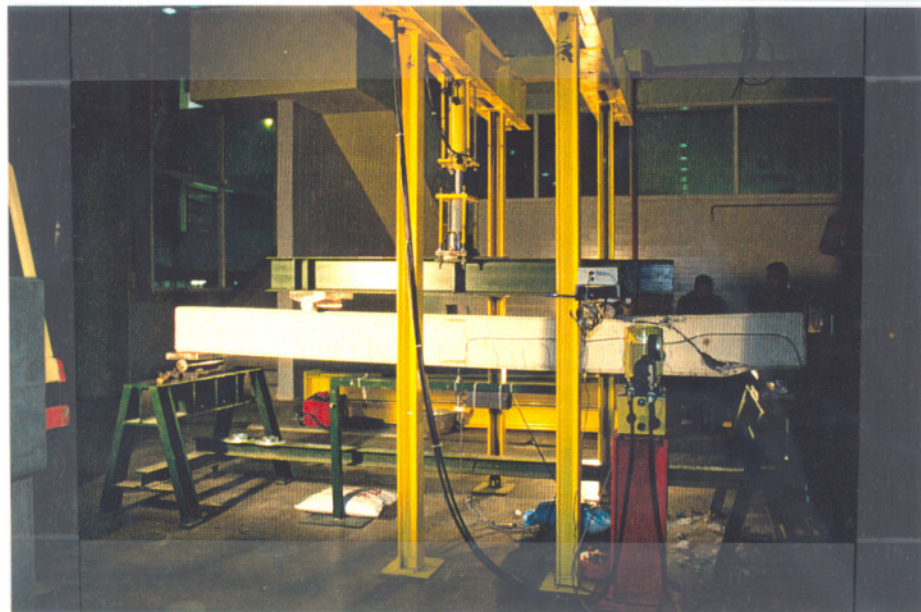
Vista general del estado final de la viga C24. En las vigas "C" la inclinación de la grieta fue más pendiente que en las vigas ensayadas justo después del descimbrado.
